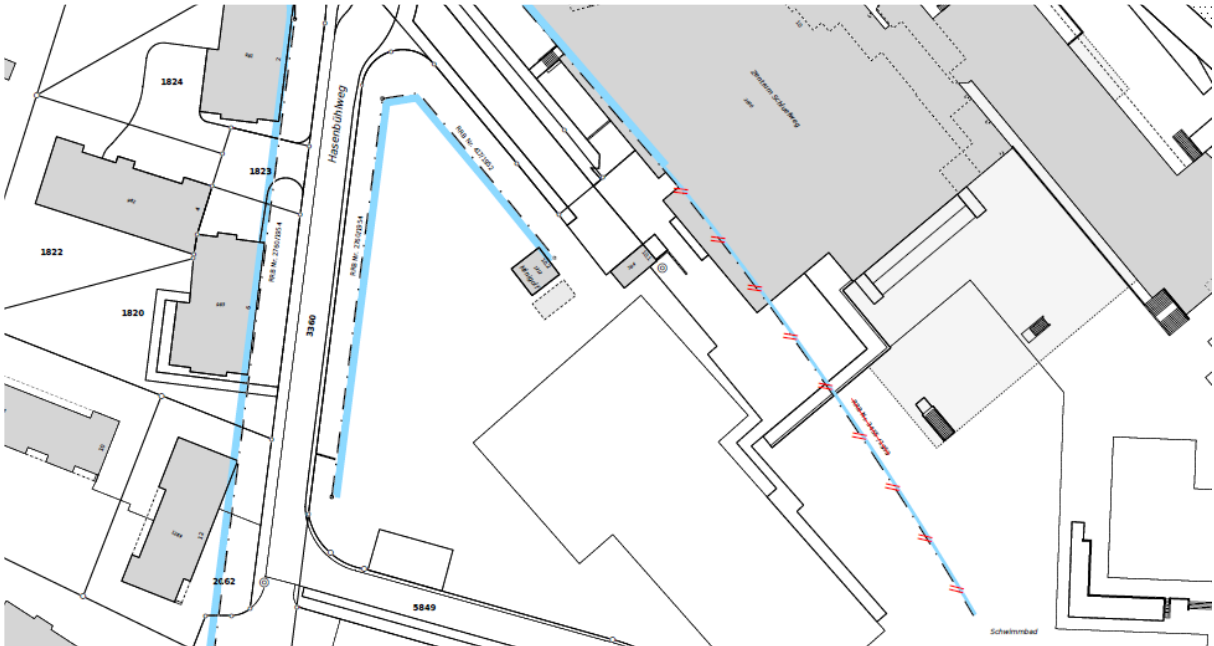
Anpassung Verkehrsbaulinien (Ausschnitt Plan «Verkehrsbaulinien Schwimmbadstrasse, Fassung Vorprüfung» vom 30.03.2021)
